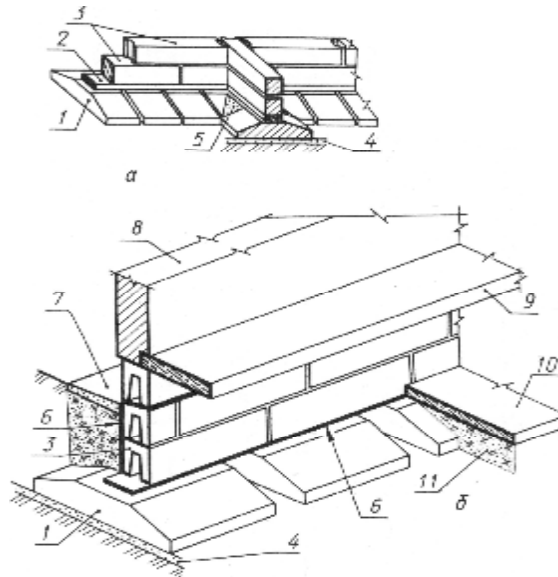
Схематичне зображення фундаментних подушок з блоками:
